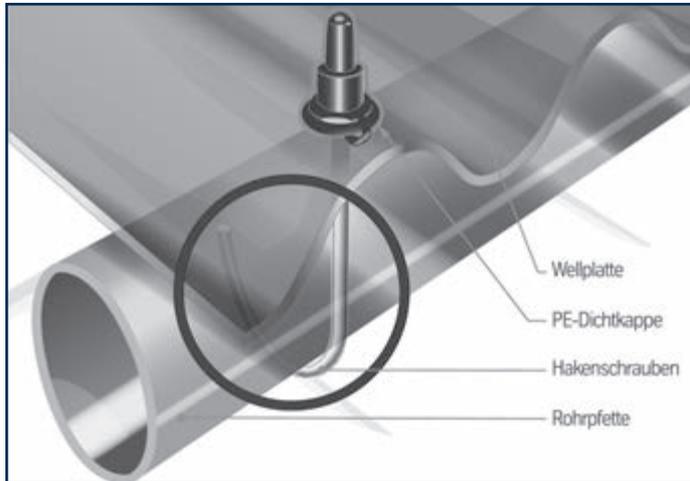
Befestigung von Wellplatten PLEXIGLAS® WP mit Hakenschraube und PE-Dichtkappe
